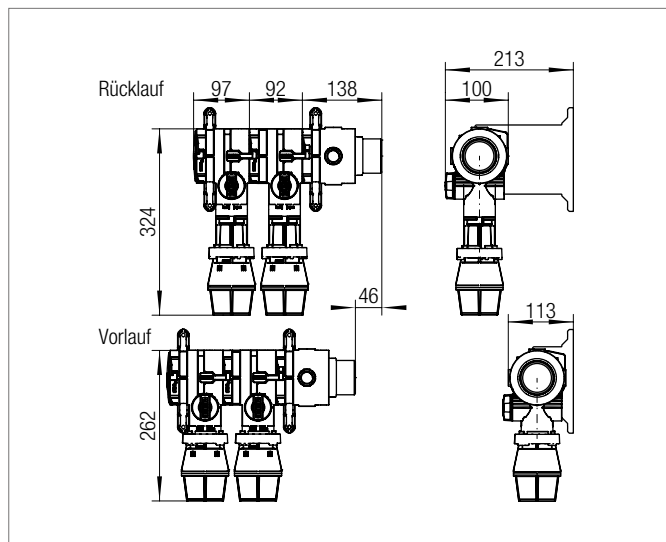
Bemaßung für RAUGEO CLICK 2-fach Verteiler mit Steckfiting DN50 und Wandhalterung
